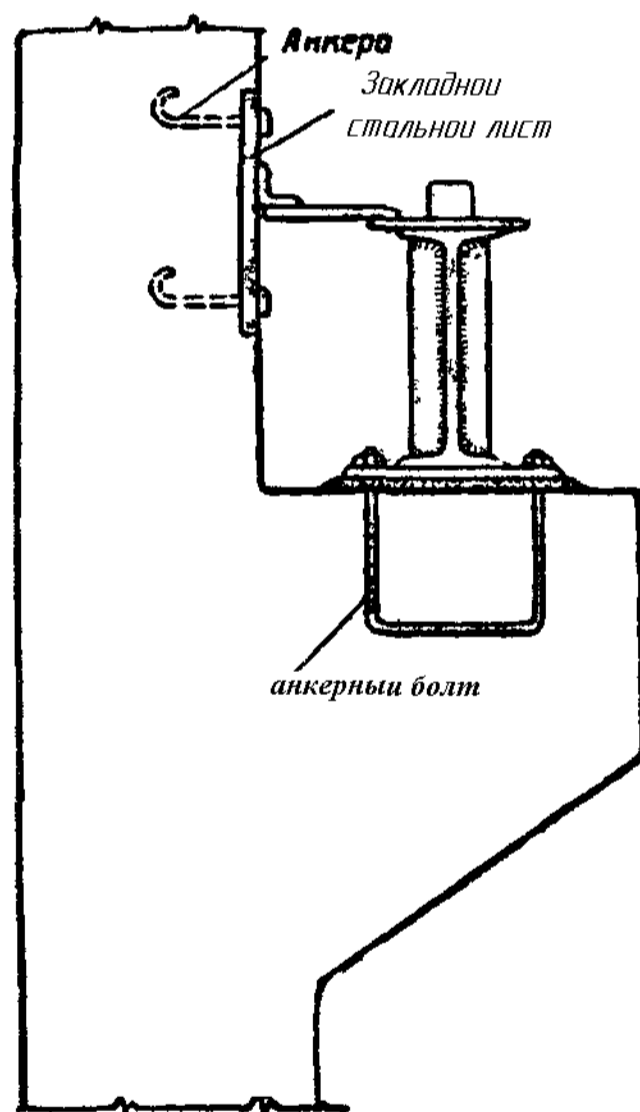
Прикрепление стальных подкрановых балок к железобетонной колонне
